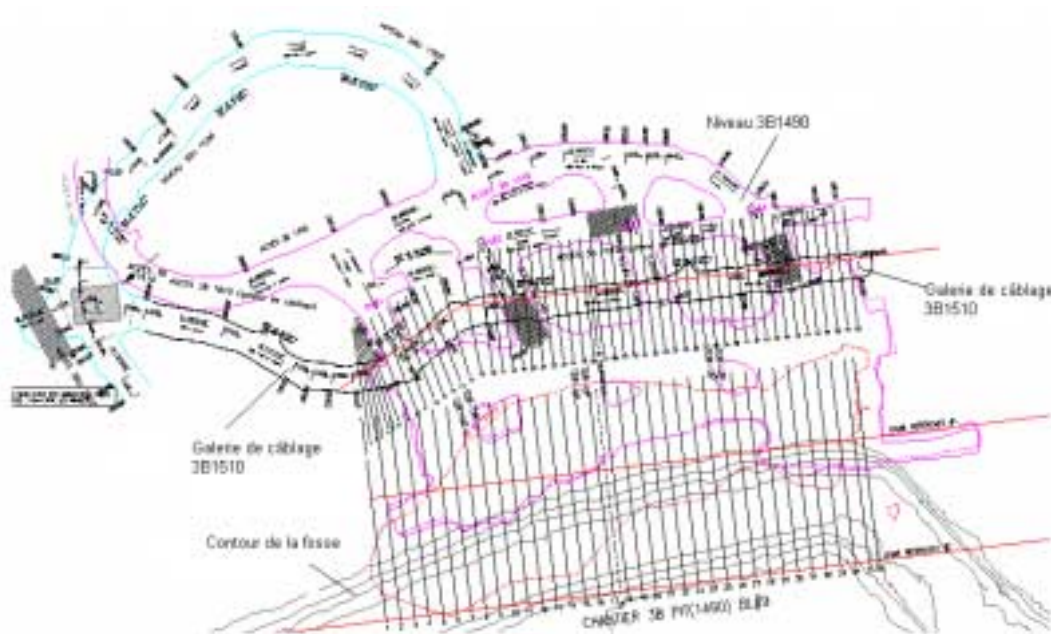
, Vue en plan du pilier de surface et galeries de câblage et soutirage
